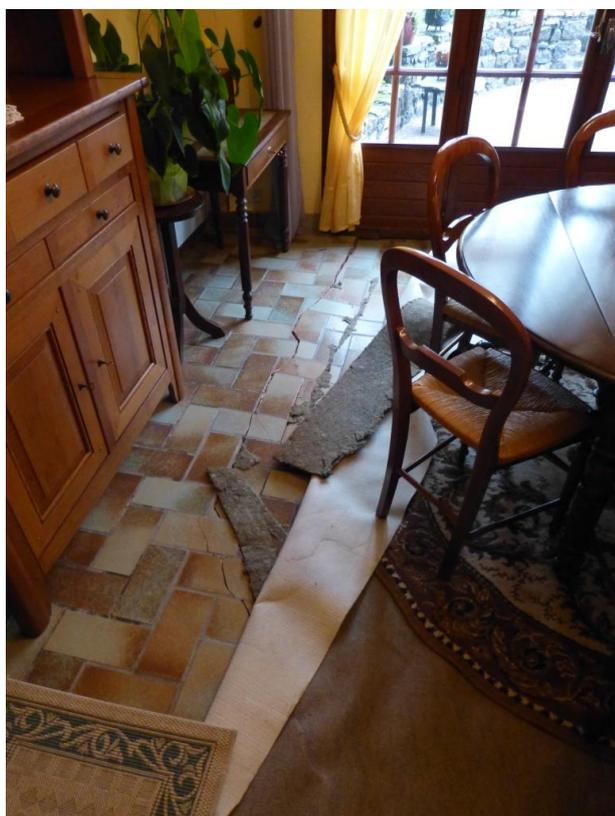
Fissure transversale dans la salle à manger (photo BRGM)
